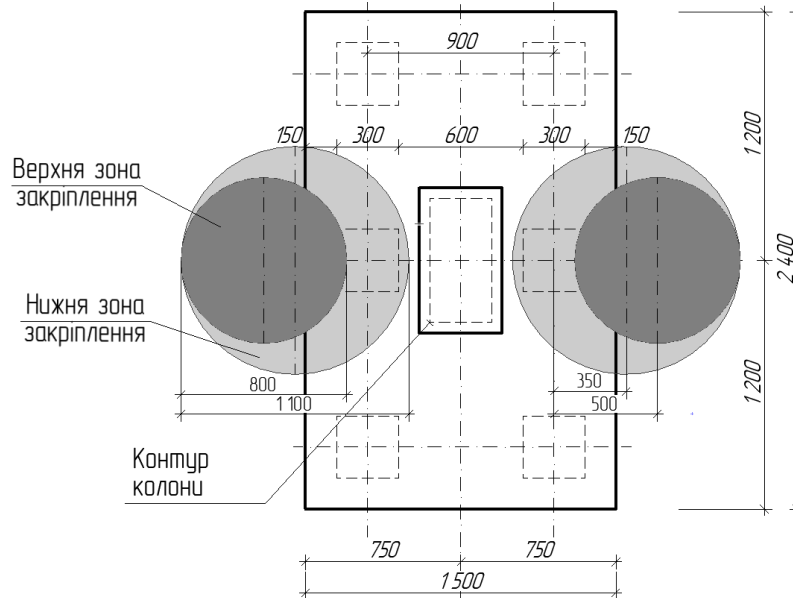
Розрахункова схема підсилення пального фундаменту ін'єкування розчину силікату натрію під кутом.
